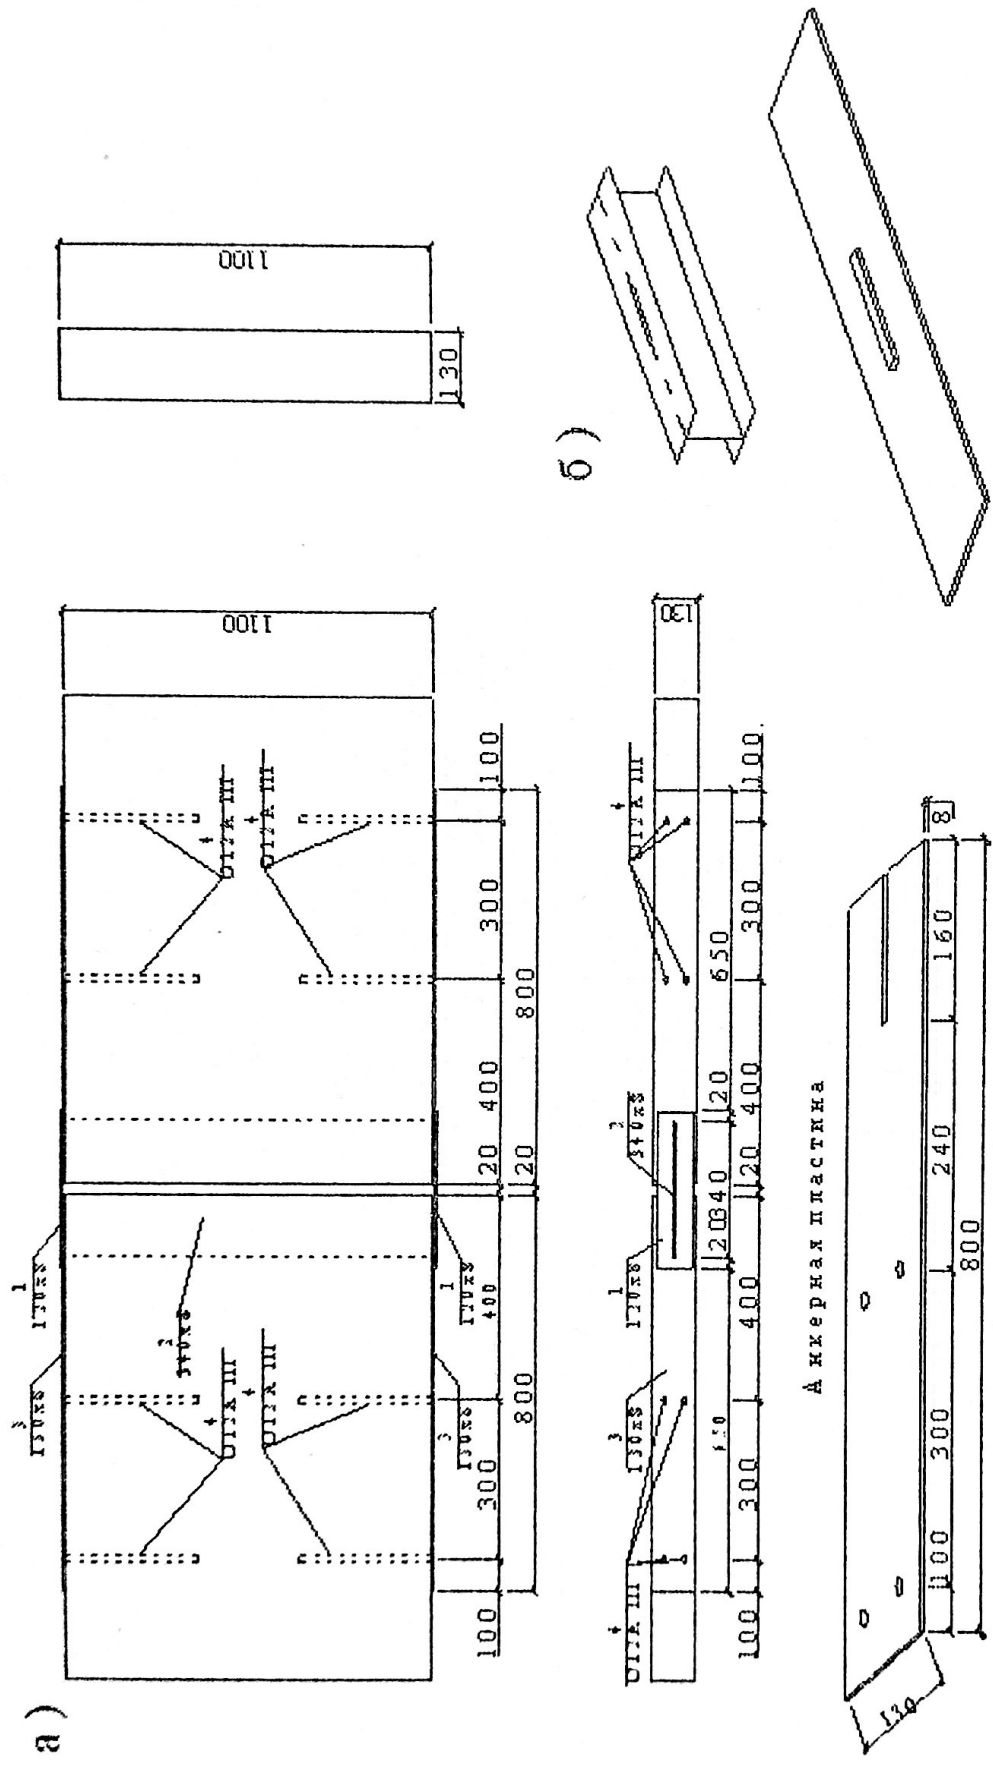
Узловое соединение клеюшашных элементов сечением 130x100 мм разработанное на кафедре МД и ПК ОГАСА.
